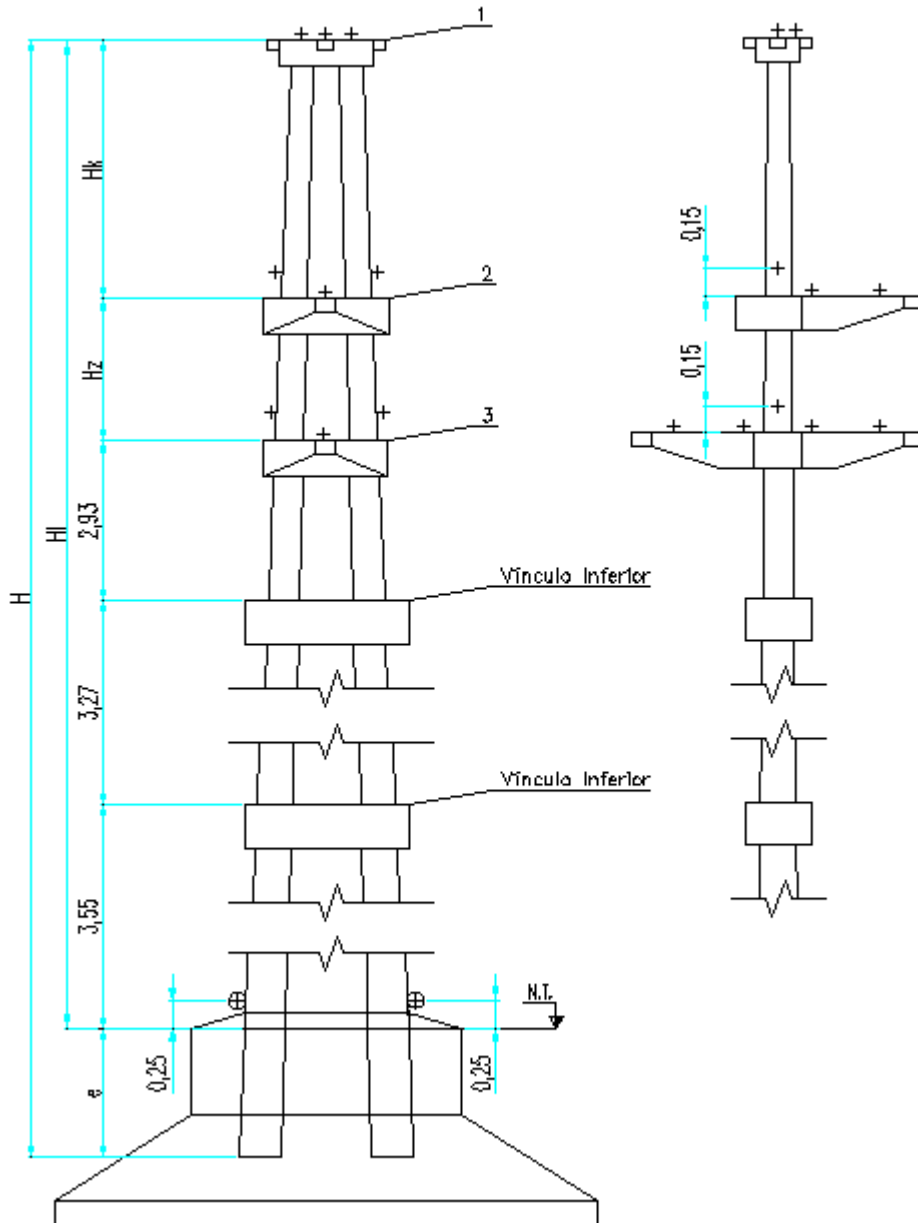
PLANO TÍPICO PARA FABRICACIÓN DE UN ESTRUCTURA DOBLE (TIPO CONSTRUCTIVO⁷)
